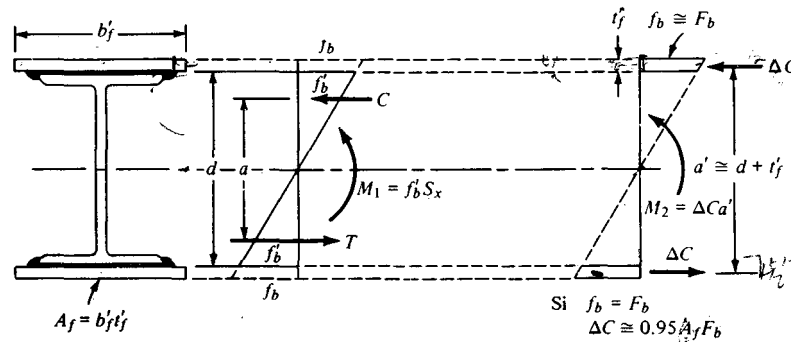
Distribución del esfuerzo de flexión en la sección transversal de una viga armada.
